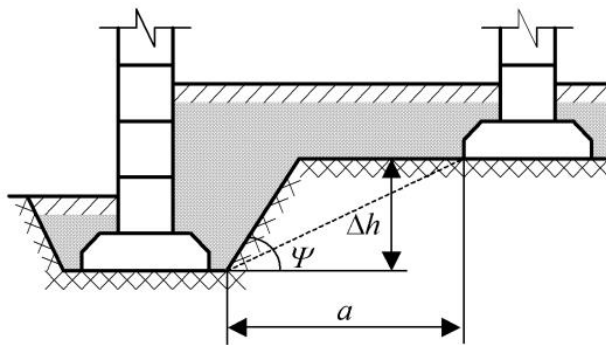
Схема закладання сусідніх фундаментів на різній глибині
